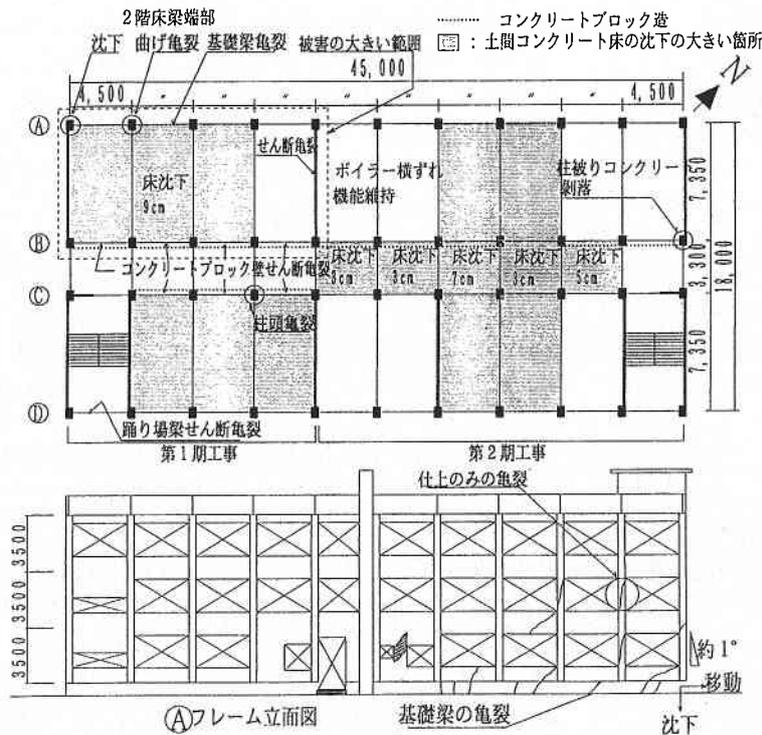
青苗小学校の平面図(1階)、立面図及び被害状況³⁾
